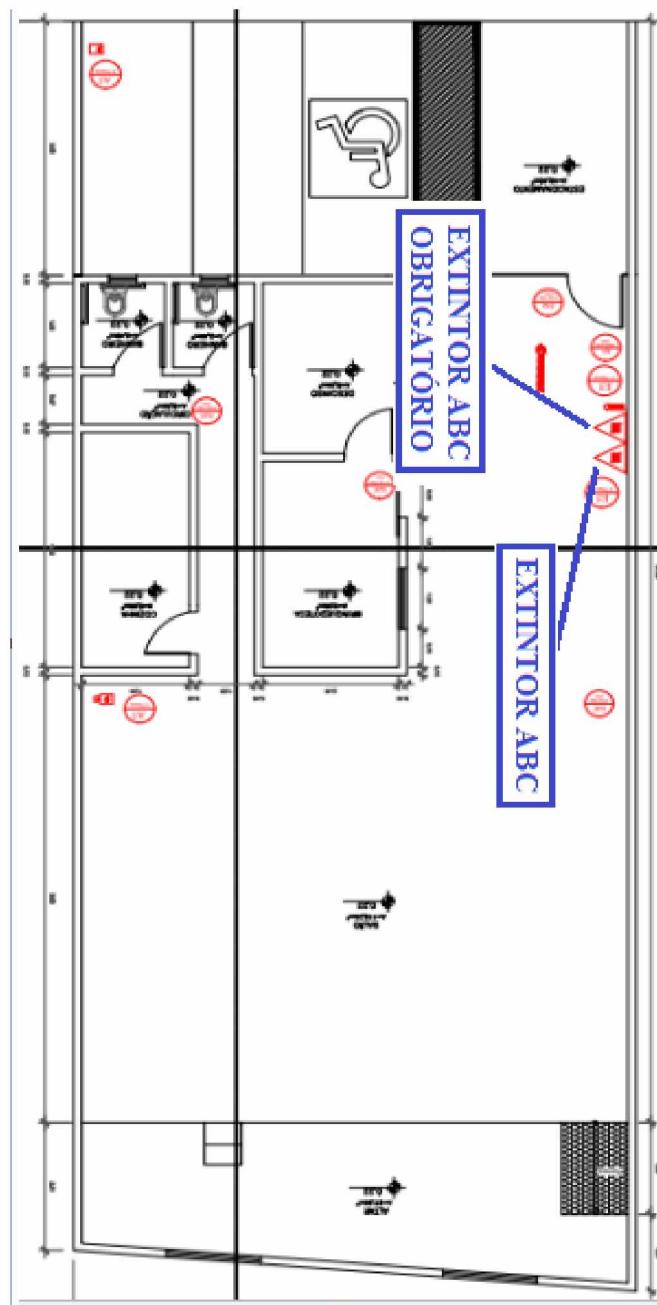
Planta baixa de proteção e combate a incêndio da Igreja Batista.
